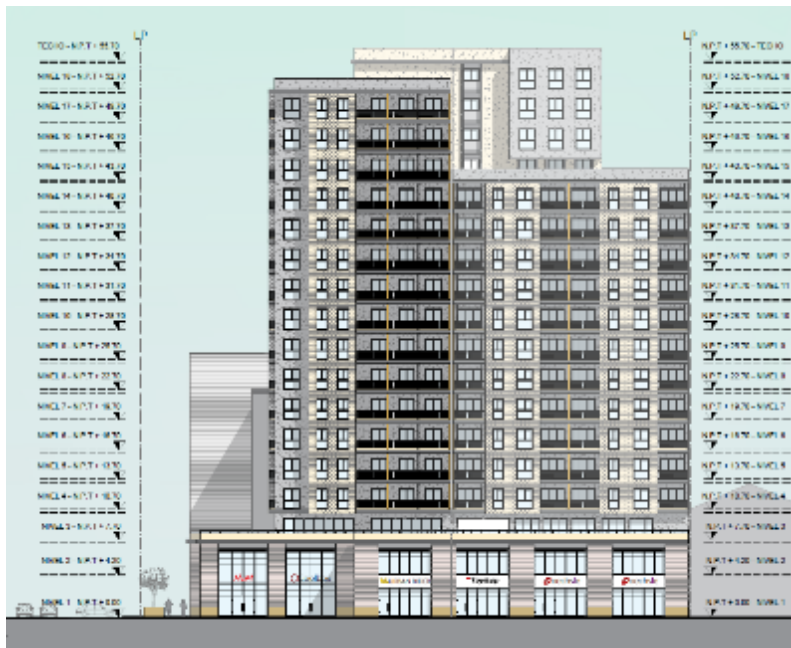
Corte F-F' transversal.Nota. Creación propia (2023).
